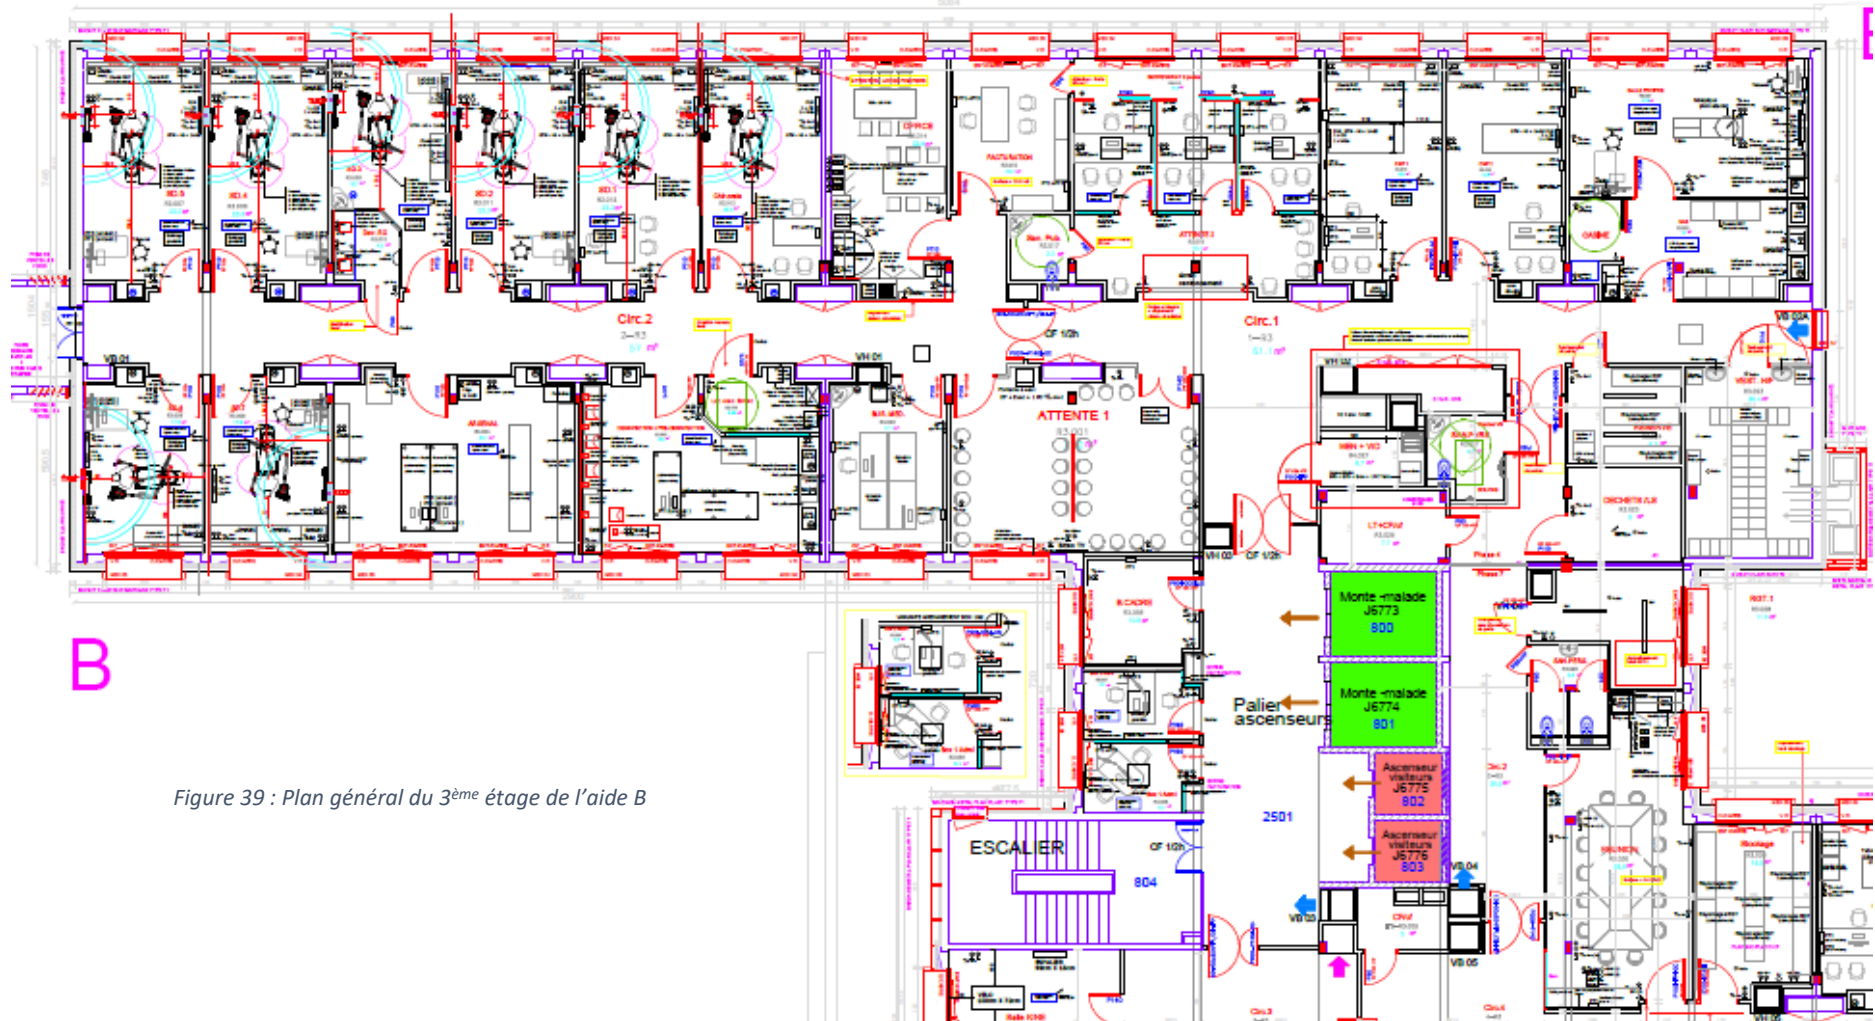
Plan général du 3^{ème} étage de l'aide B
